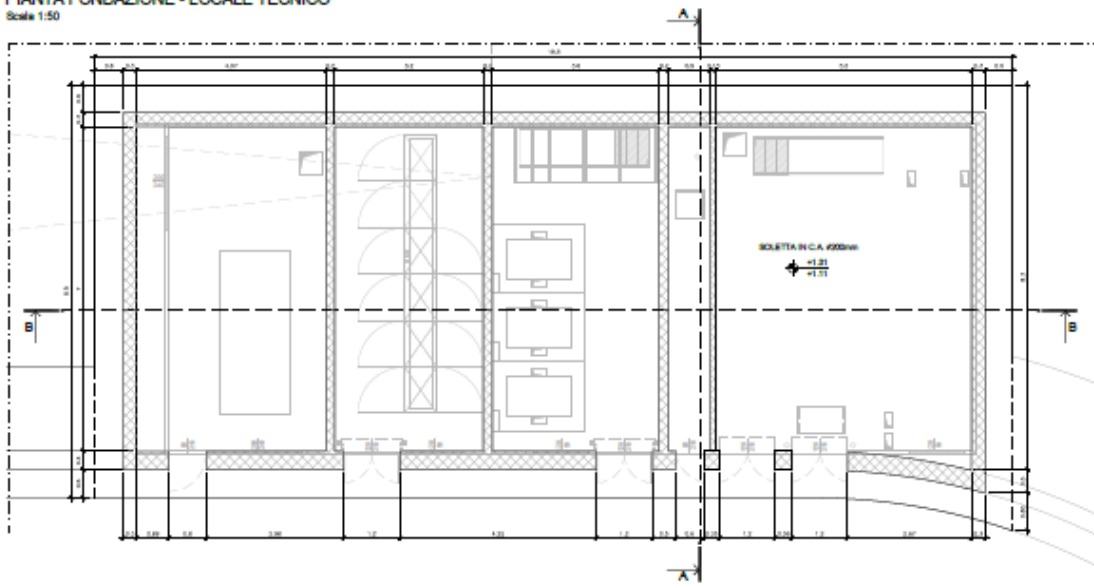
Pianta - Estratto dalla tavola C14 - Locale tecnico
